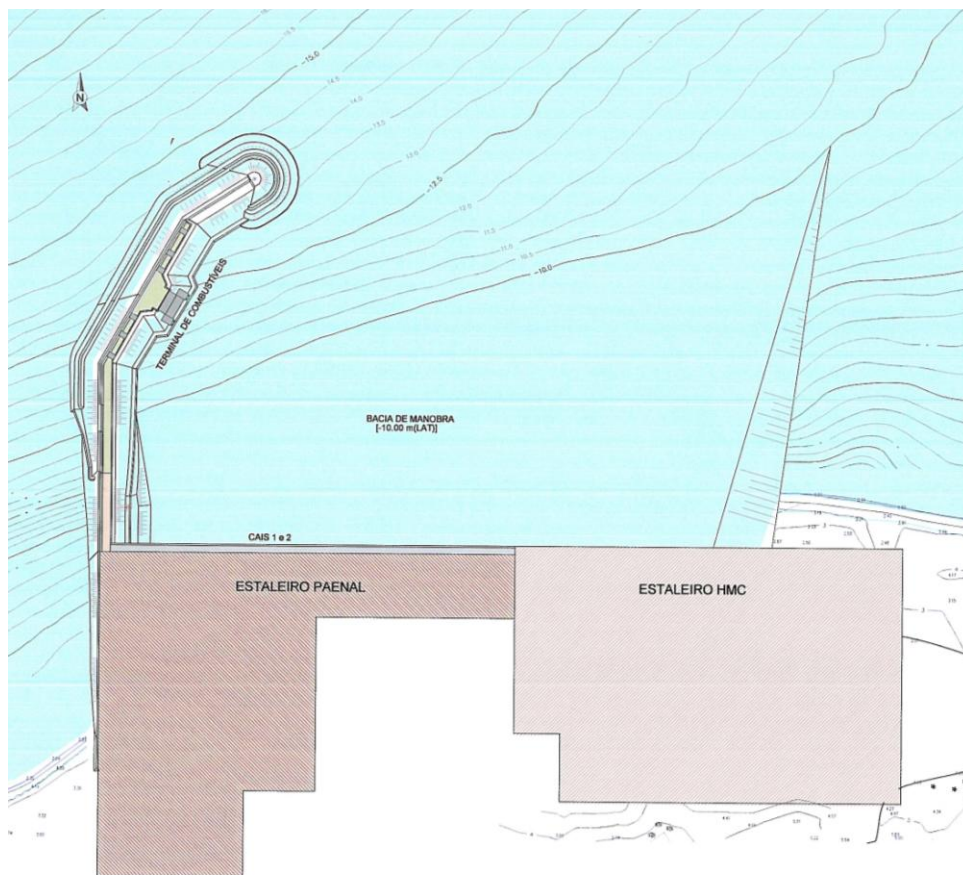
Planta geral da área de estaleiros navais de Porto Amboim
